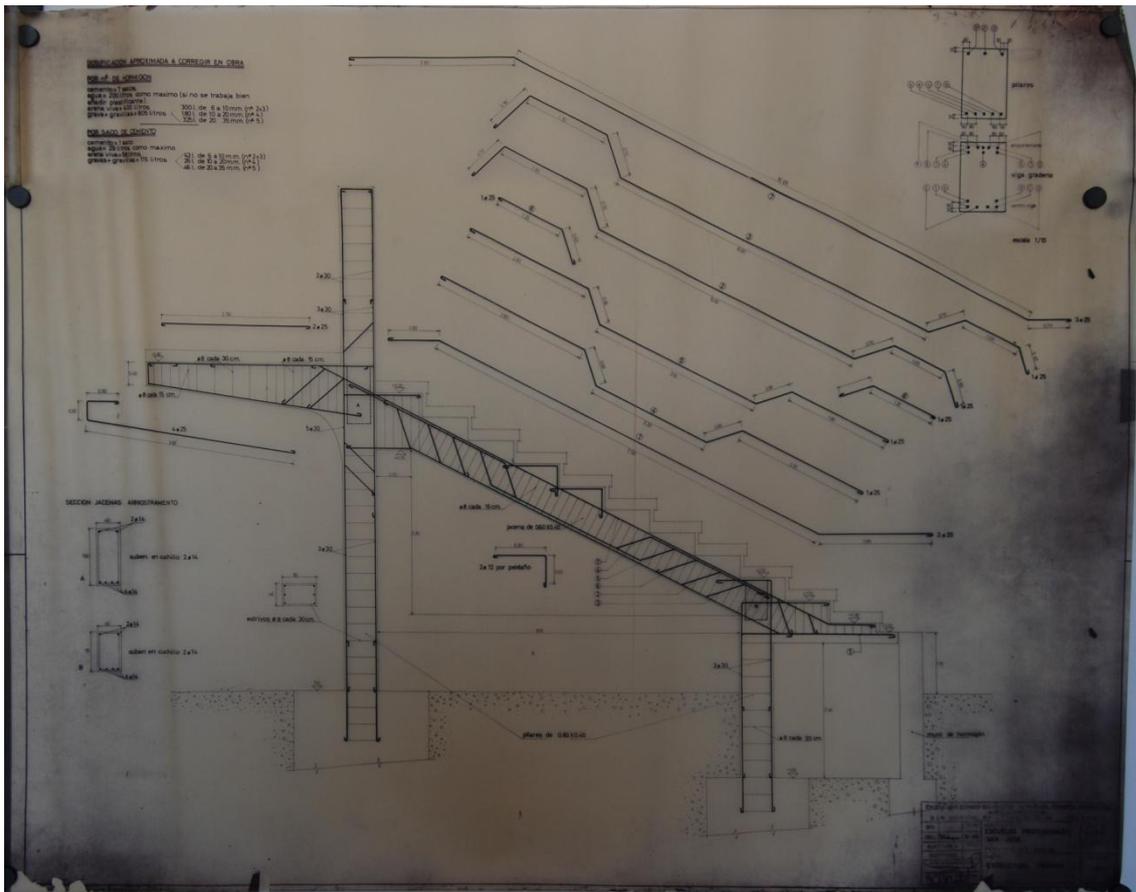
Sección constructiva de las gradas. Archivo Escuelas San José.
